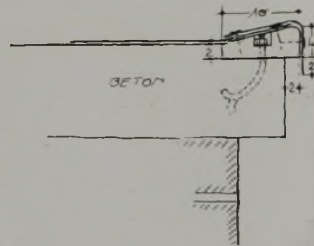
Ueberstehende Traufbohle am Betondach, mit Streinschrauben befestigt. Einfache Dichtung durch Traufenbleche, deren Nagelung durch die obere Papplage überdeckt ist.
